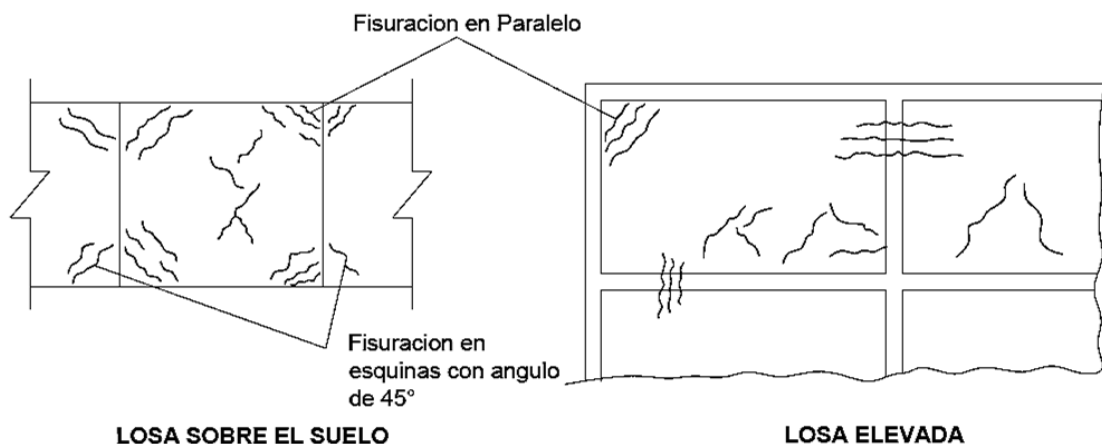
Fisuración por contracción plástica en losa de concreto
